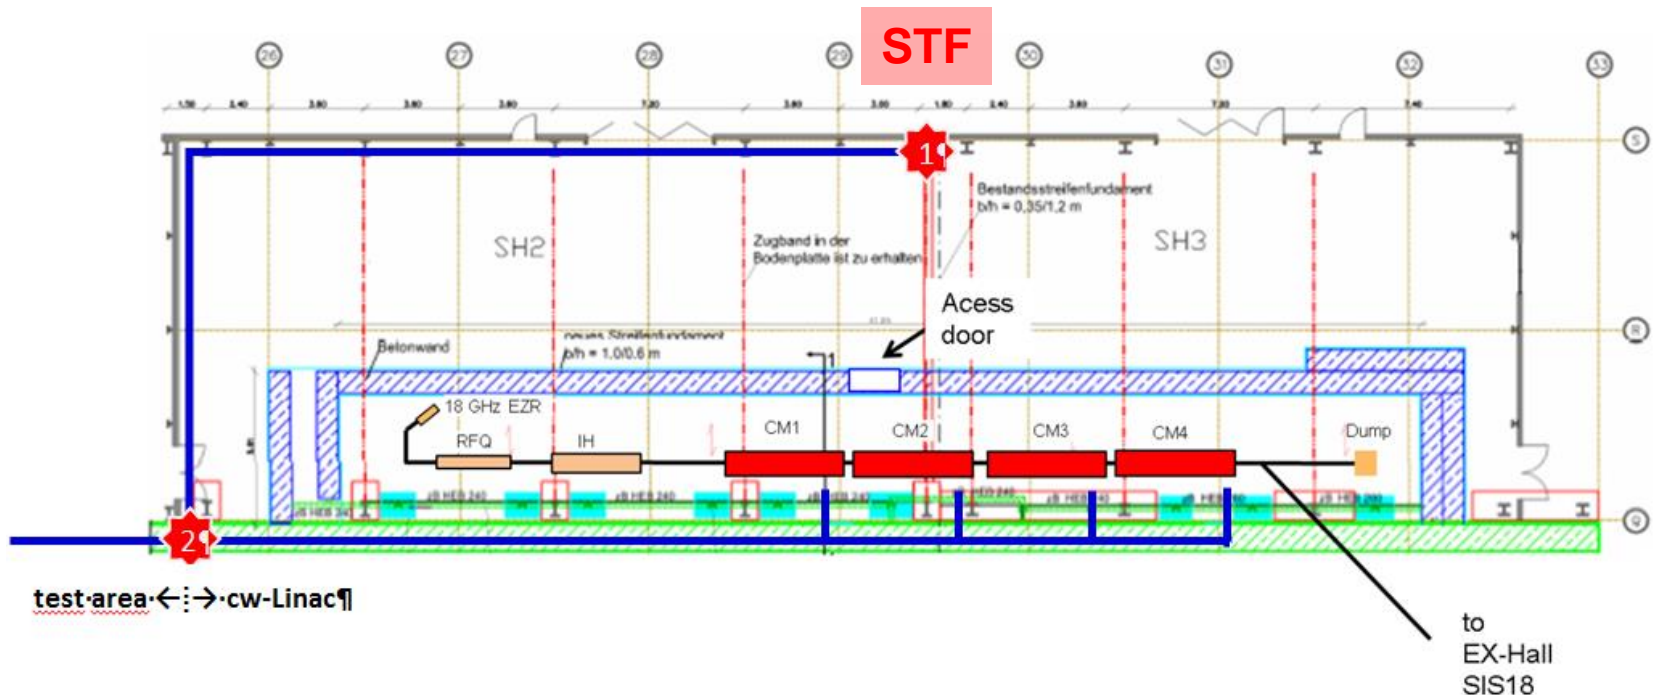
Querschnitt mit Darstellung der geplanten Betonabschirmung
